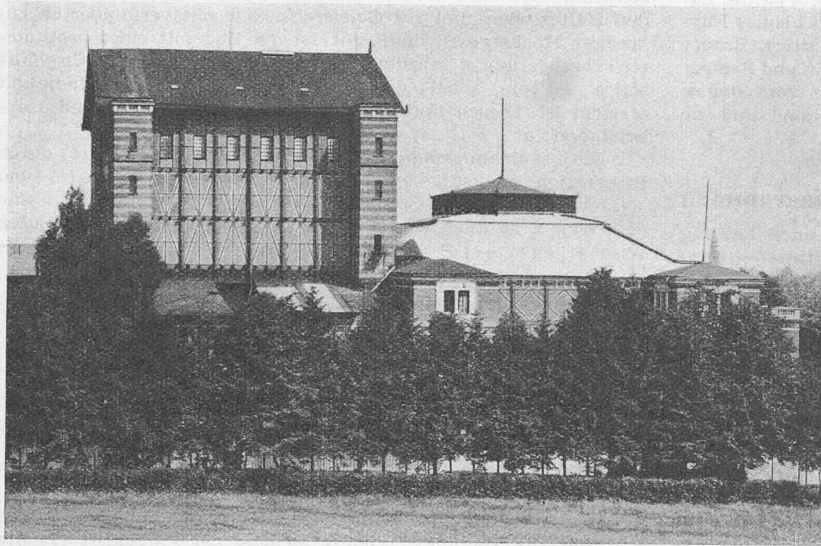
Westansicht, Riegelbau, Bühnenhaus mit vier gemauerten Eckversteifungen
